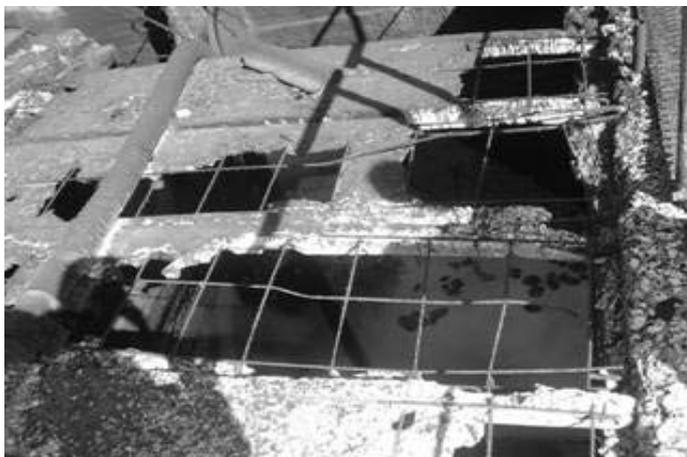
Общий вид повреждений перекрытия нефтеотделителя
